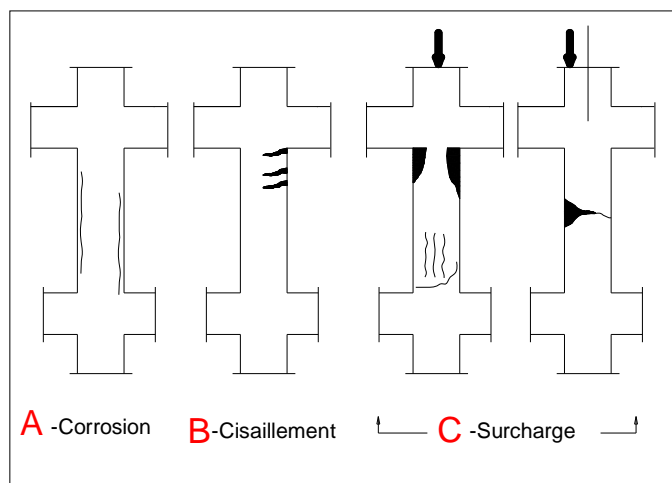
Fissures probables affectant les poteaux.
